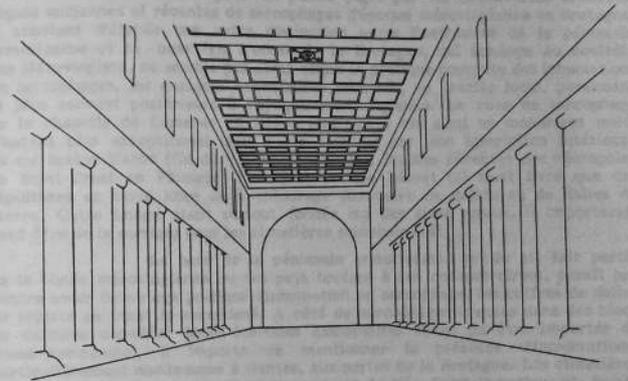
Utilisation présumée de carreaux en terre cuite comme caisson de plafond.
